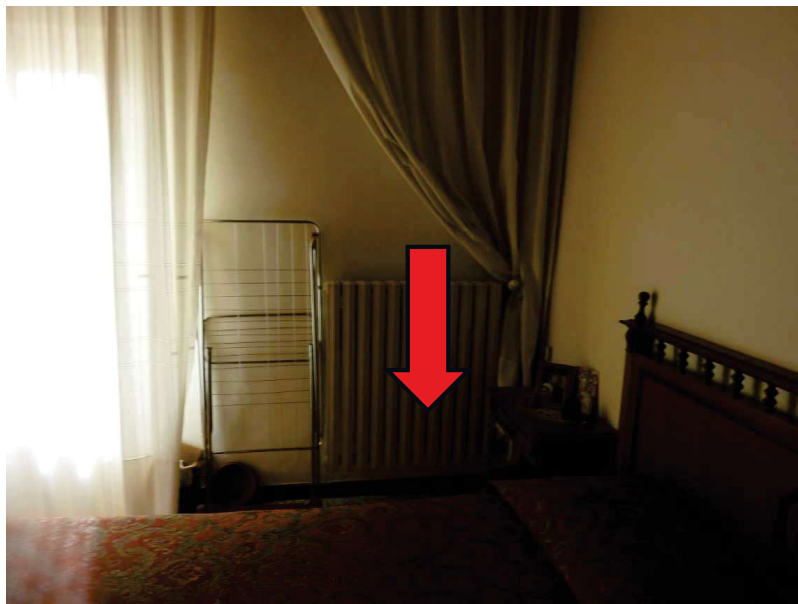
< Stanza da letto, con ingresso posizionato sulla sinistra del pianerottolo di riposo della rampa scale – Prospetta con balcone su Via Cavallerizza - Alleg. N. 03>
